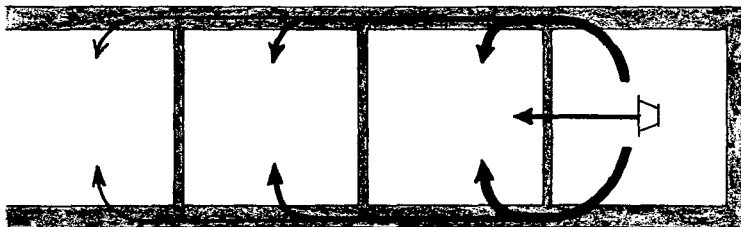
Nebenwegübertragung bei durchgehenden Außenwänden und Geschoßdecken (Schematische Darstellung)
